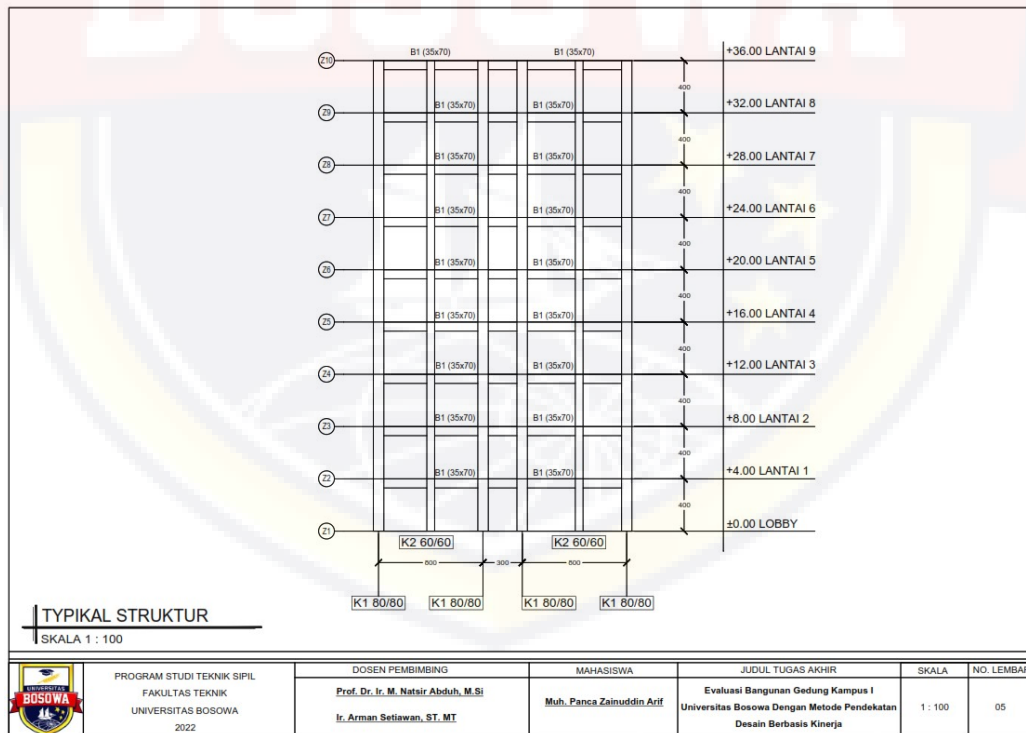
Typikal struktur kolom gedung lantai 5 - 9
